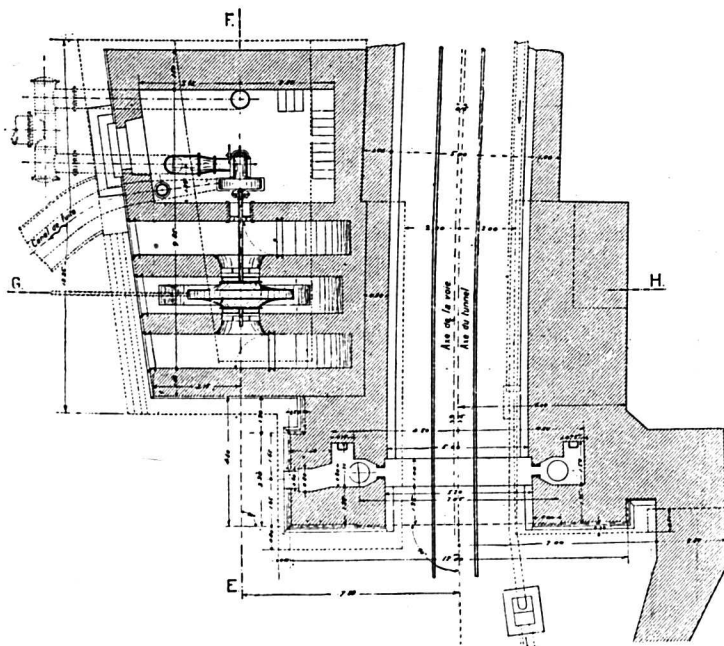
Installation de la ventilation du tunnel, du côté de Brigue. Coupe horizontale par A B, à la hauteur du ventilateur du rez-de-chaussée.
